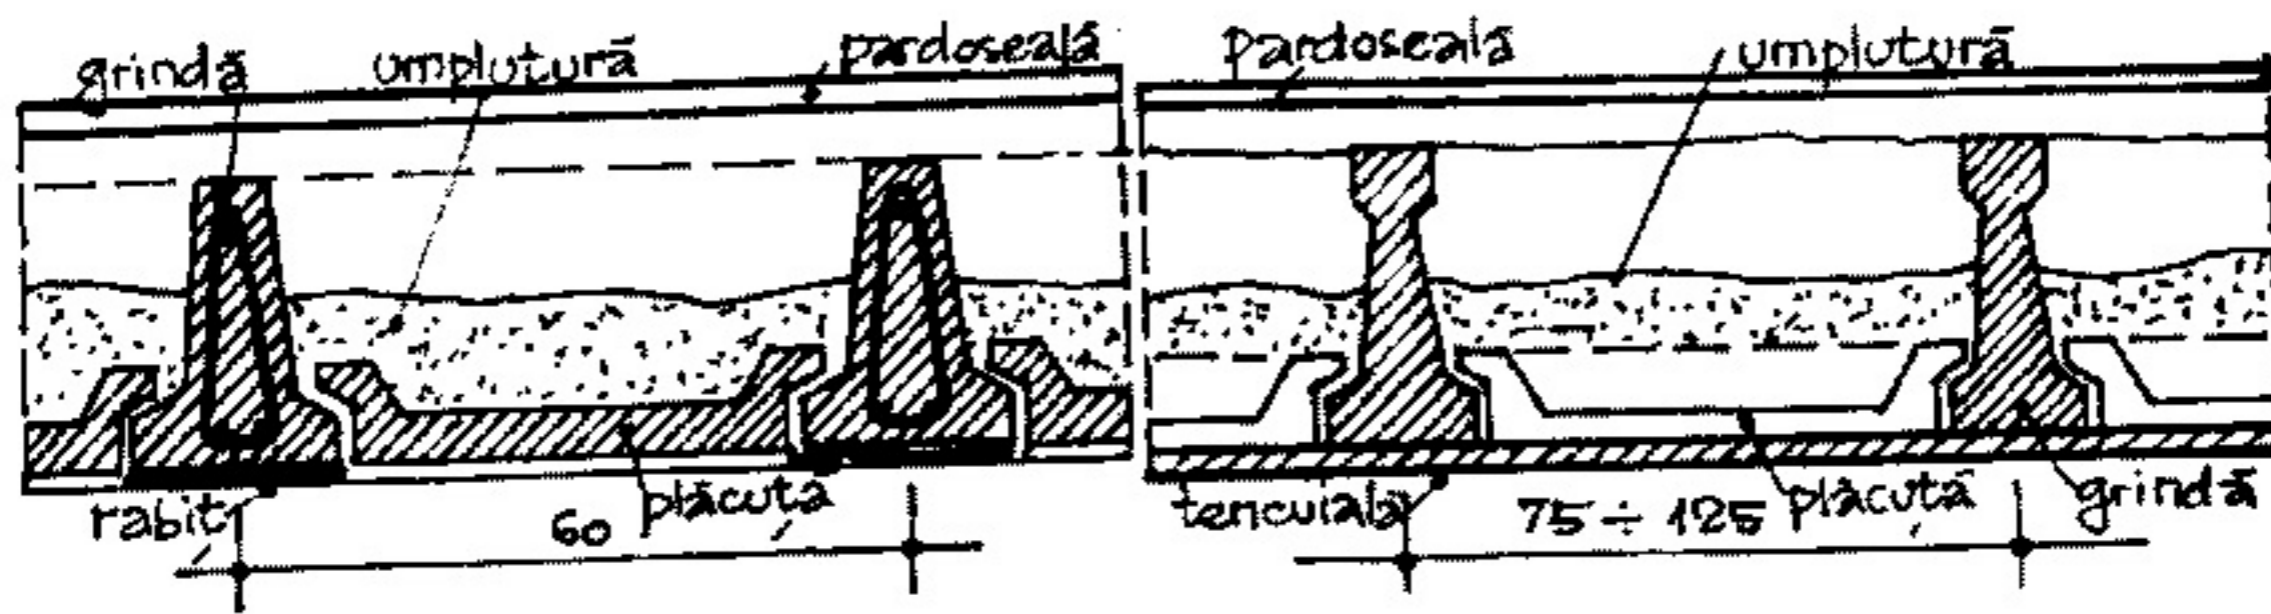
Planșee cu plăcuțe din beton armat, ipsos sau argilă arsă
